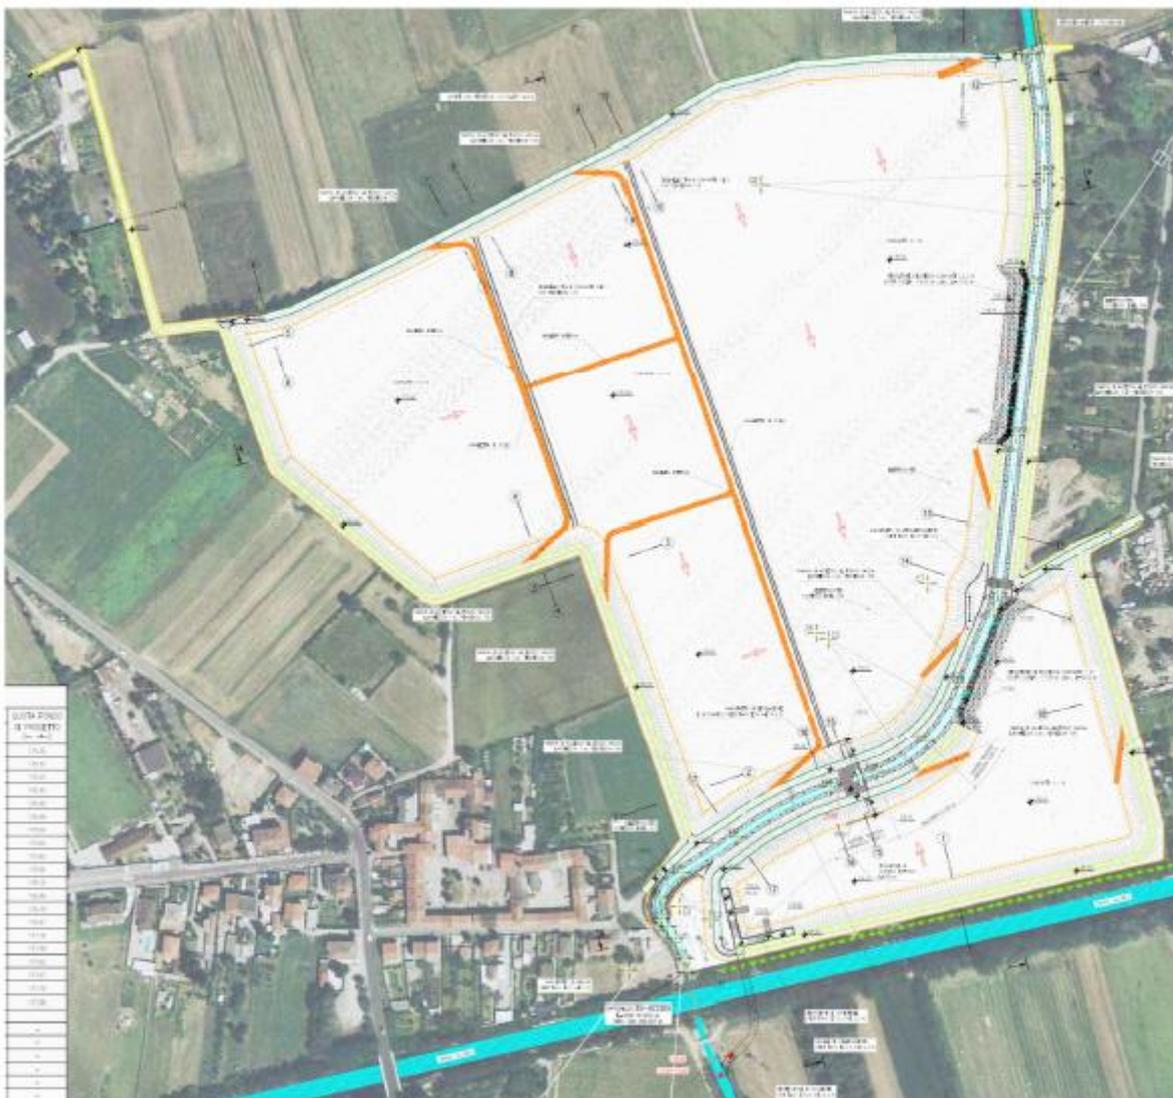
Planimetria progetto area laminazione di Nerviano (Fonte: Progetto Esecutivo AIPO, 2014)
